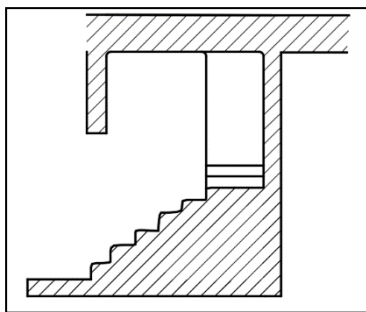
escaiers sur blockage de pierres. source: fait par l'auteur
